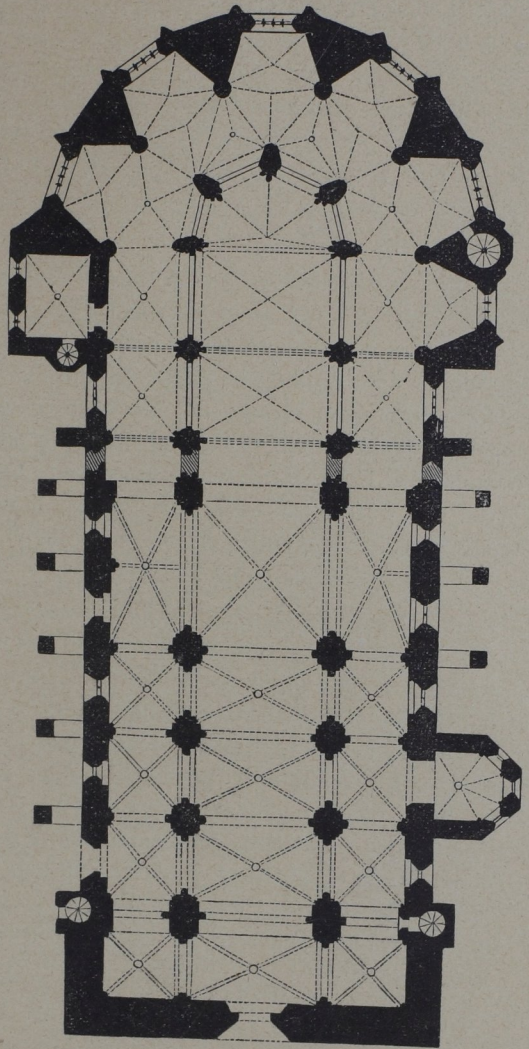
Grundriss der Bartholomäuskirche in Kolin.
